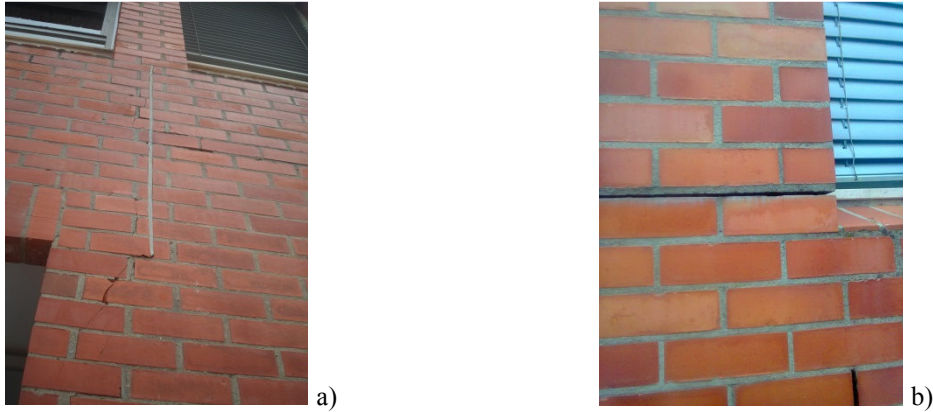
Fissuras no revestimento em tijolo face-à-vista
